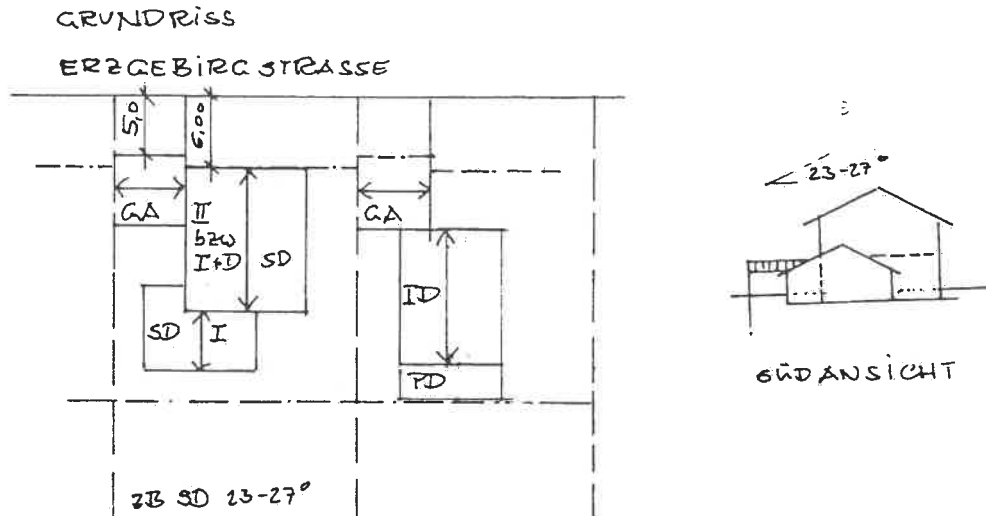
Alternative in Grundriss und Ansicht von Süden mit Sattel- und Pultdach, ca. M 1:500
